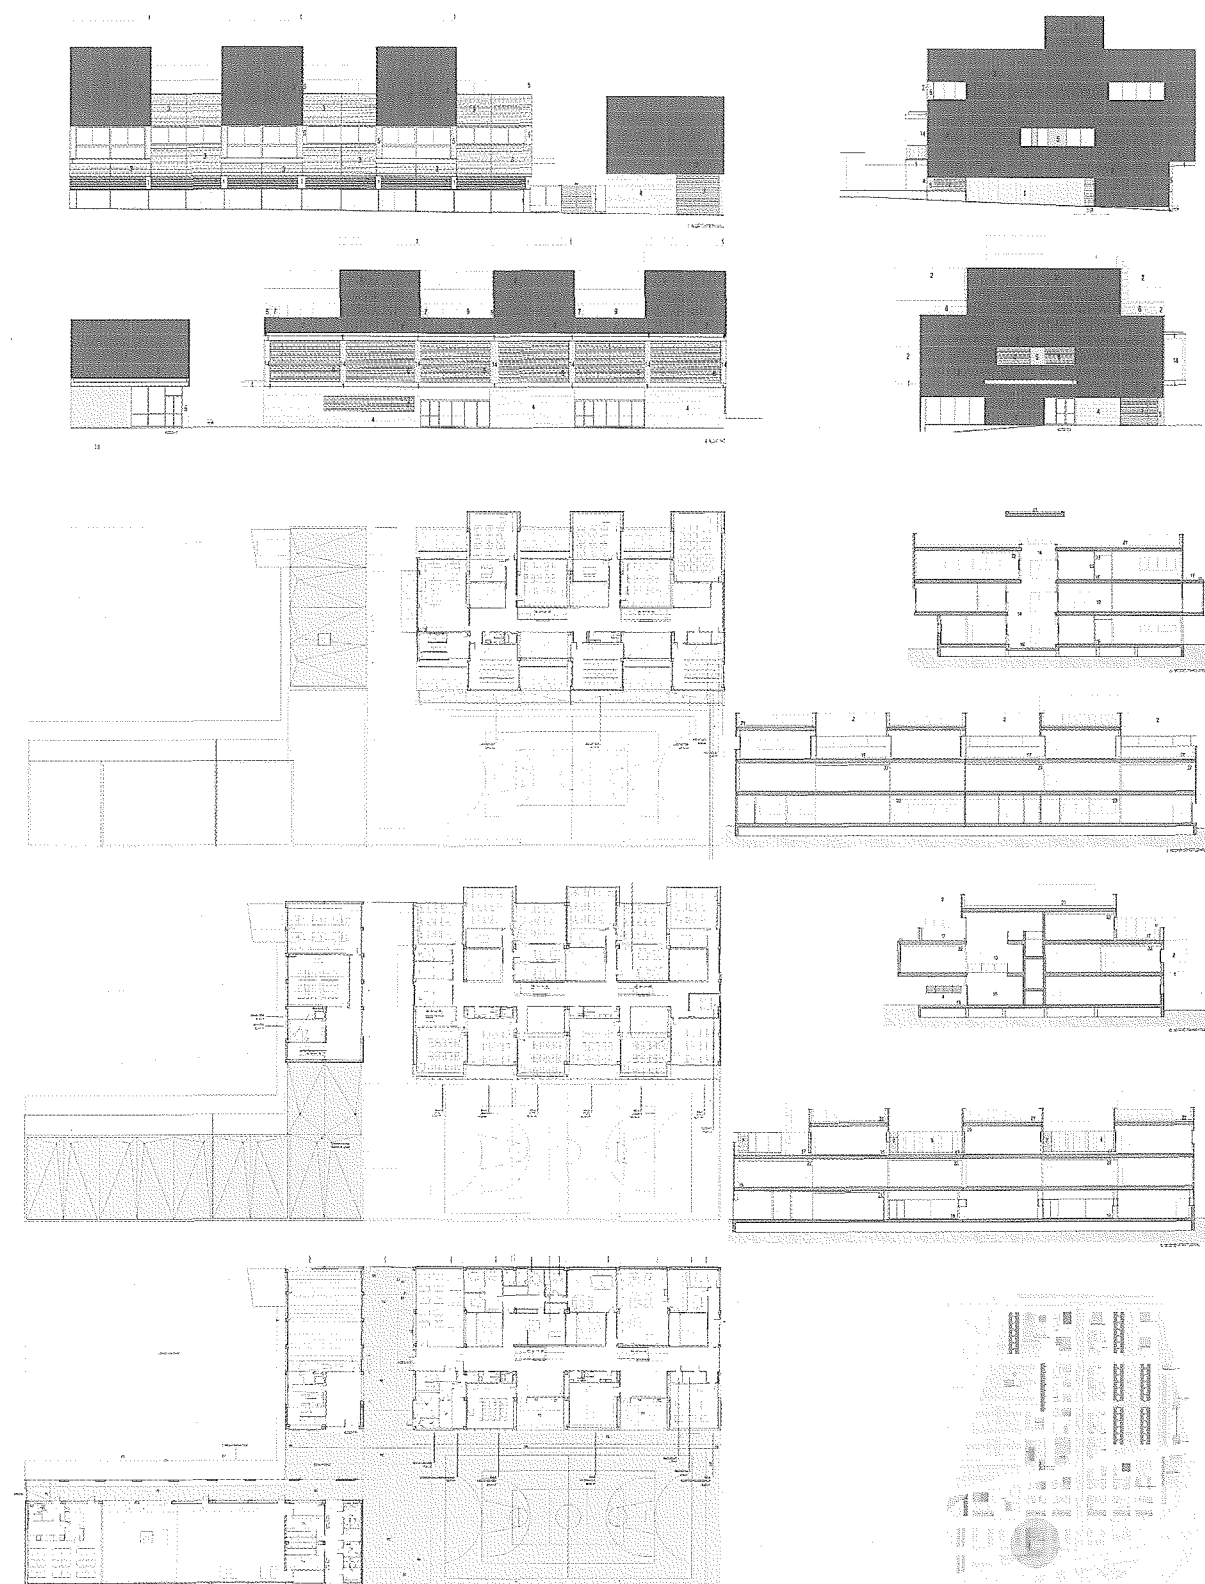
Nuevo Instituto de Enseñanza Secundaria con frente a calles Llul y Taulat; J. Pascual Argente y Ramón Ausió i Mateu. Alzados, plantas, secciones y localización. Ejecutado.
